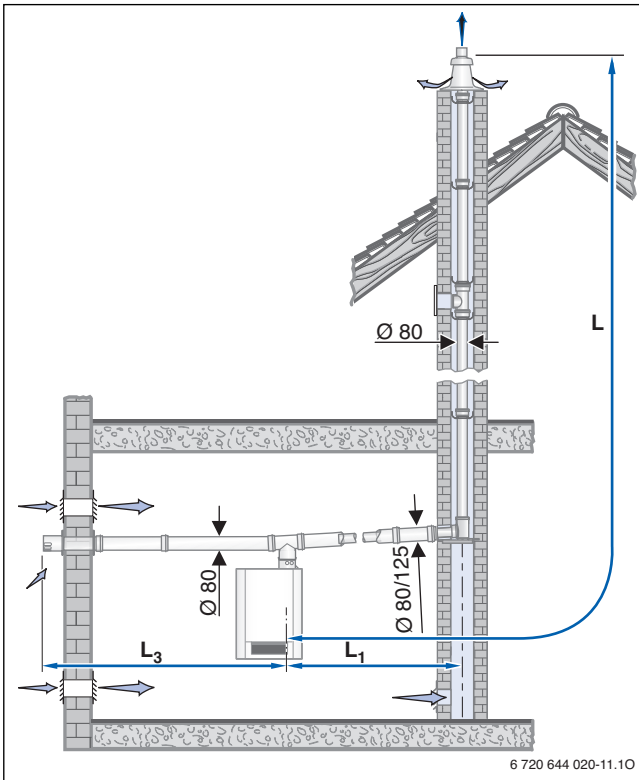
Montagevarianten mit dem Bausatz GAL-K + GA-K
